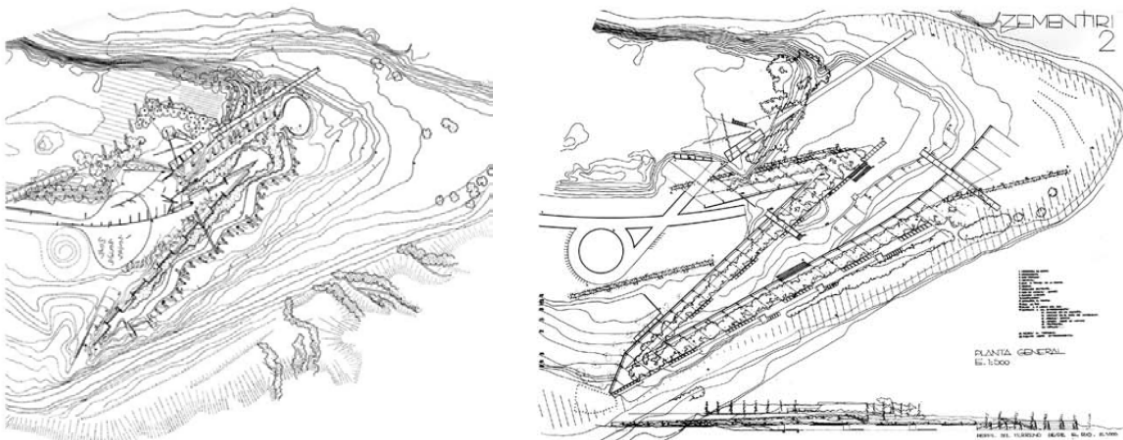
Planta de entorno (izqda.) y planta general del Cementerio de Igualada (dcha.). El Croquis nº 49/50. Enric Miralles y Carme Pinós.
